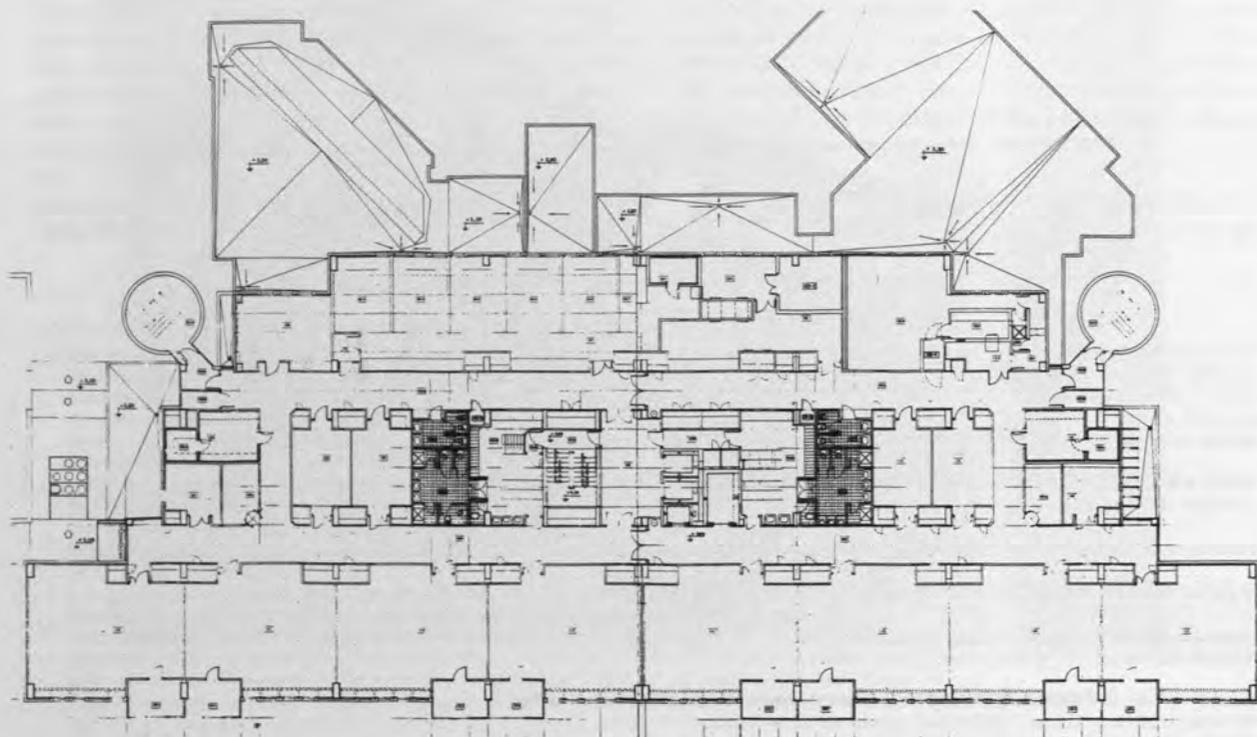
TERSSE & COLMENARES: Centro Nacional de Ingeniería Genética y Biotecnología. Planta tipo. Escala 1/200.
